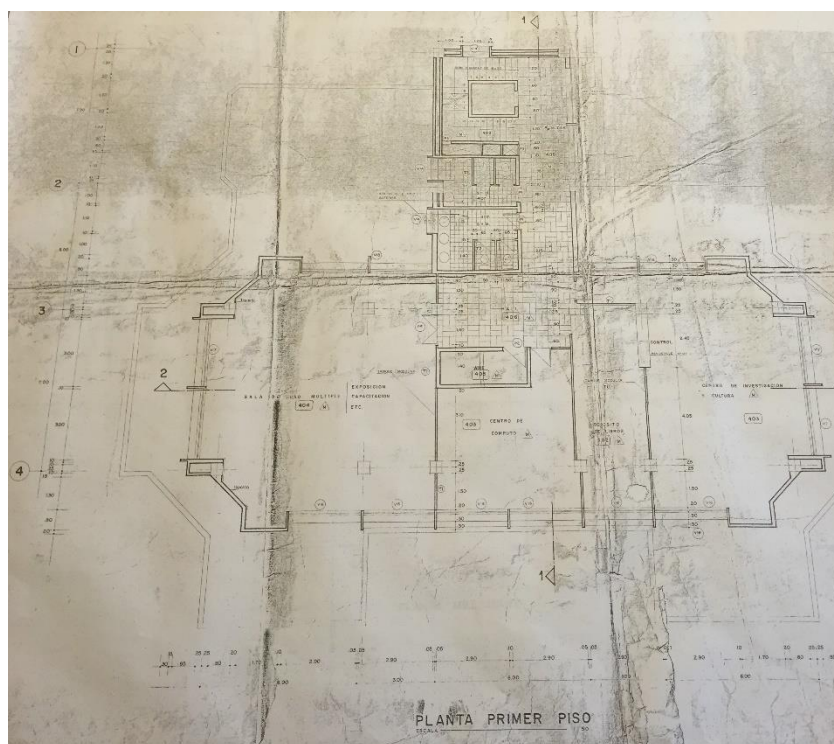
, Planta Primer Piso, edificio BNC CENTRAL, Jipijapa, Manta
